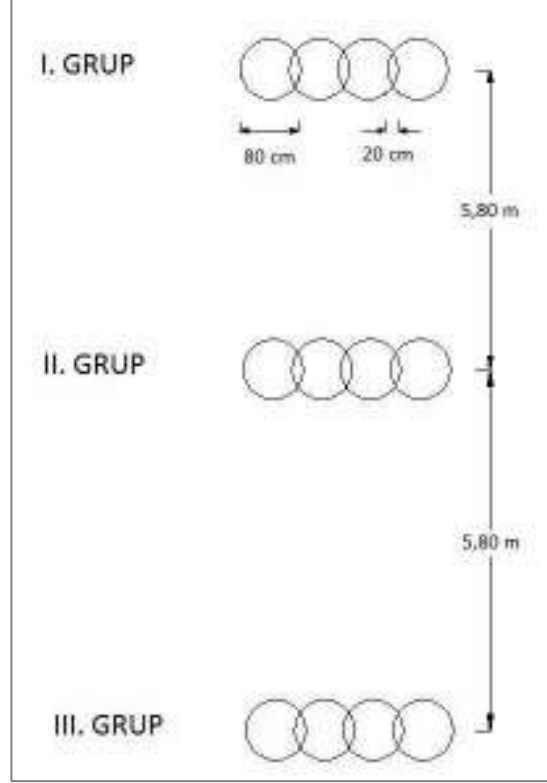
Tüneller için hazırlanan jet-grout kolonları planı.
